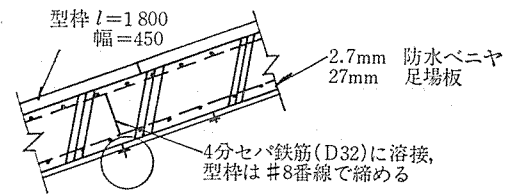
アーチリブコンクリート打継ぎ目部の処理要領図
